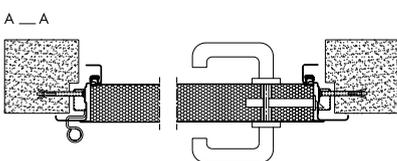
Horizontalschnitt Stahlaußentüren ECO mit Eckzarge.
